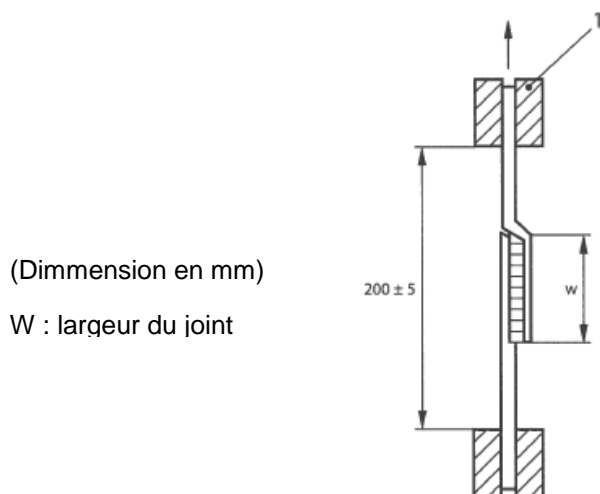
Dimensions des éprouvettes d'essais de cisaillement selon NF EN 12317-2 : 2013
